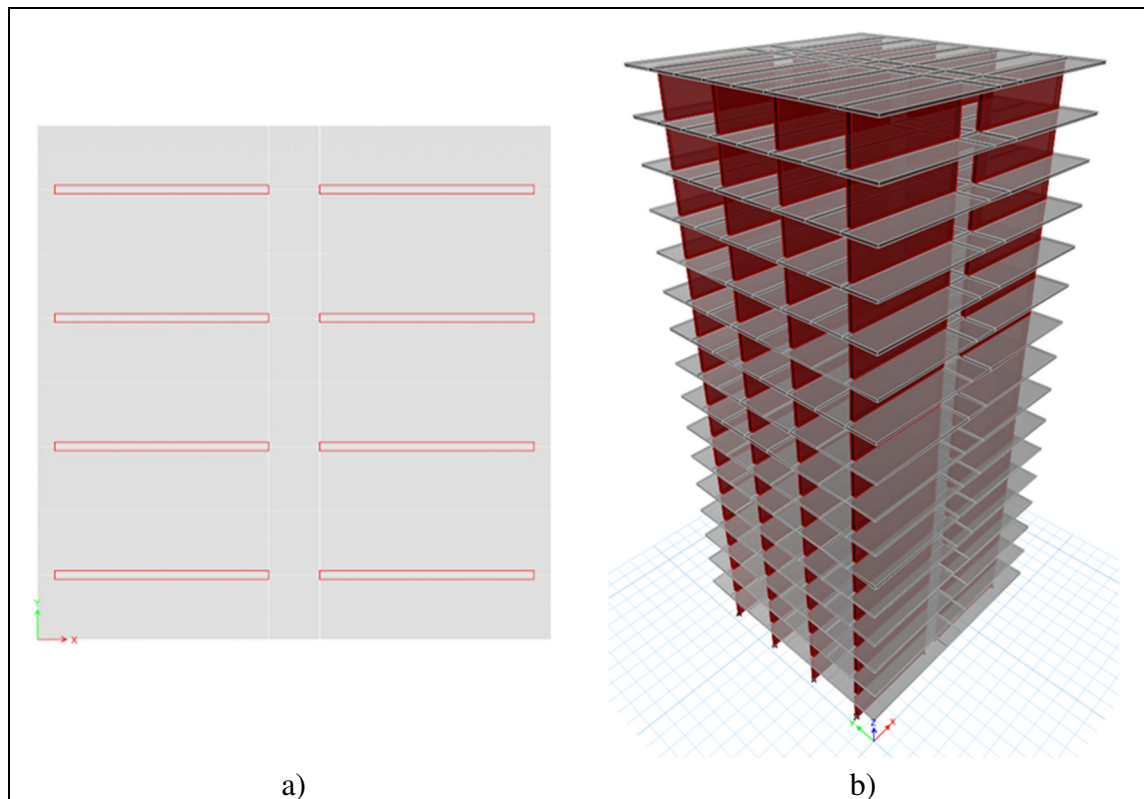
Modelo ETABS de edificio de estudio con muros rectangulares. a) Vista en planta. b) Vista en 3D.
